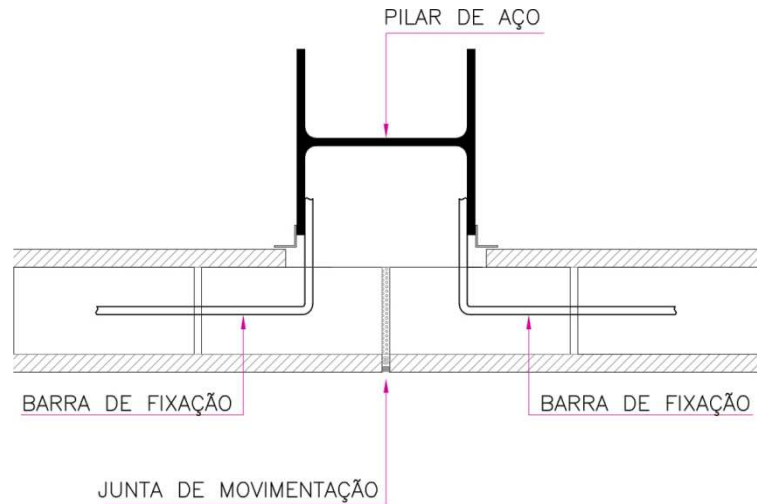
Alvenaria desvinculada fora do plano da estrutura.
